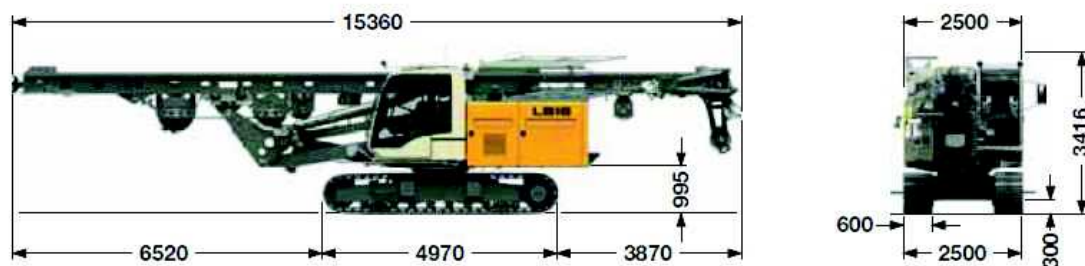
Pilotovací souprava LIEBHERR 16-180
